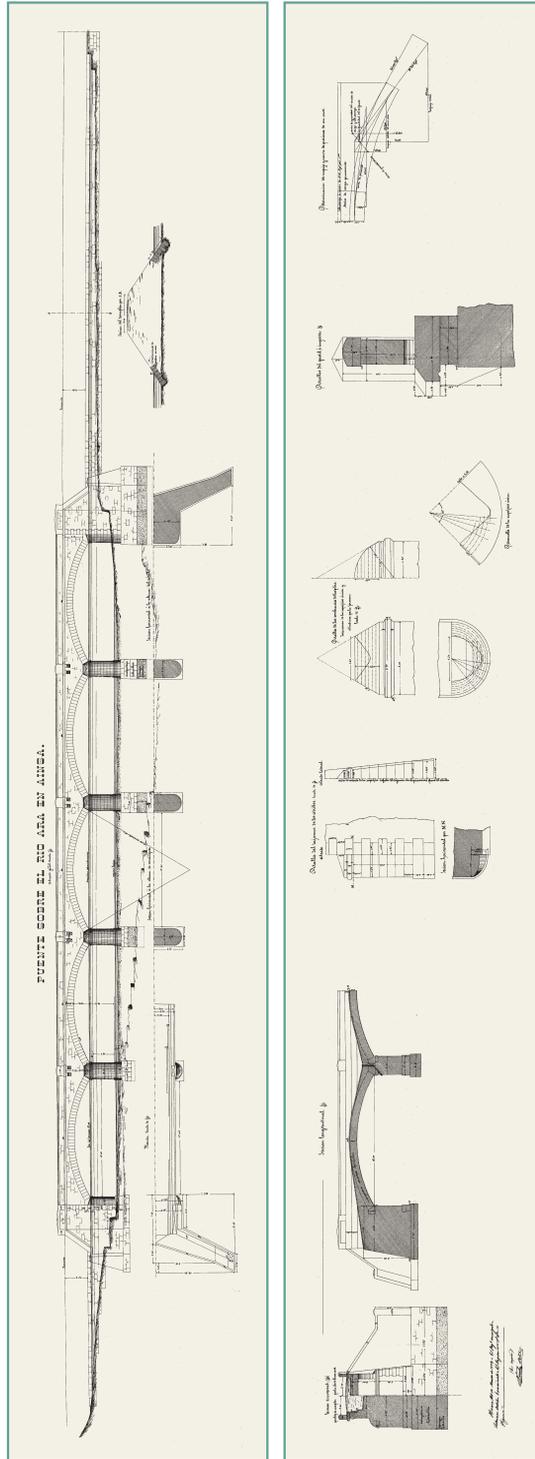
Proyecto de puente sobre el río Ara en Alinsa, alzado general y detalles. Saturnino Bellido, Huesca, 20 de marzo de 1878. AGA, Fondo de Obras Públicas (04.005), caja 2313.
